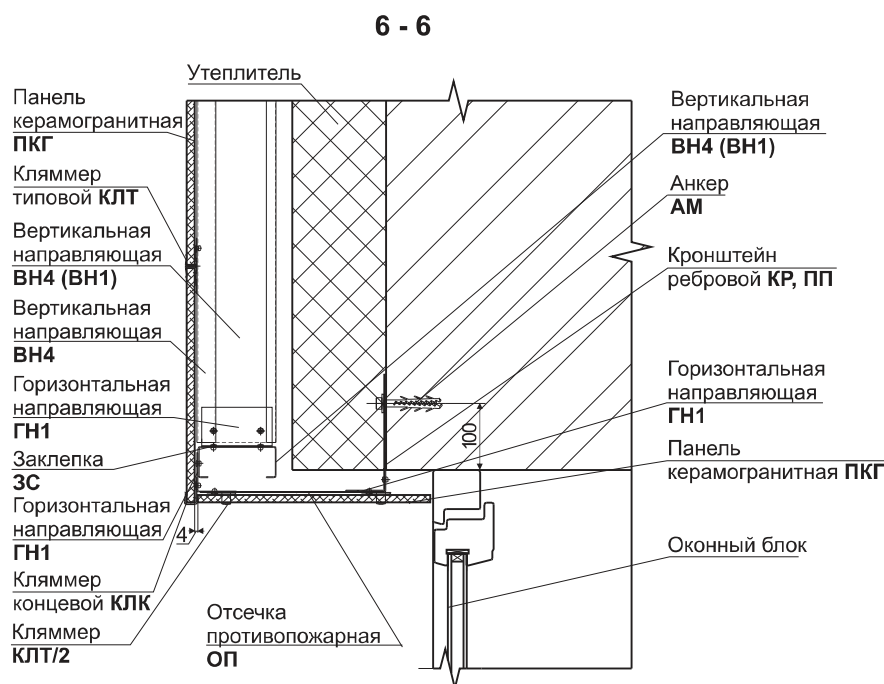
Узел облицовки верхнего откоса панелями керамогранитными. Вариант при креплении системы к междуэтажным перекрытиям.
